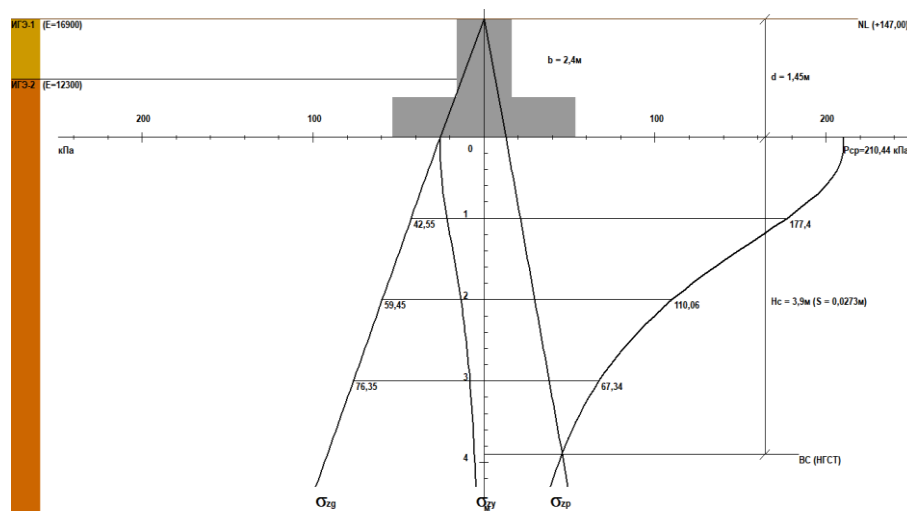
Расчетная схема к расчету осадки фундамента по оси «А»
